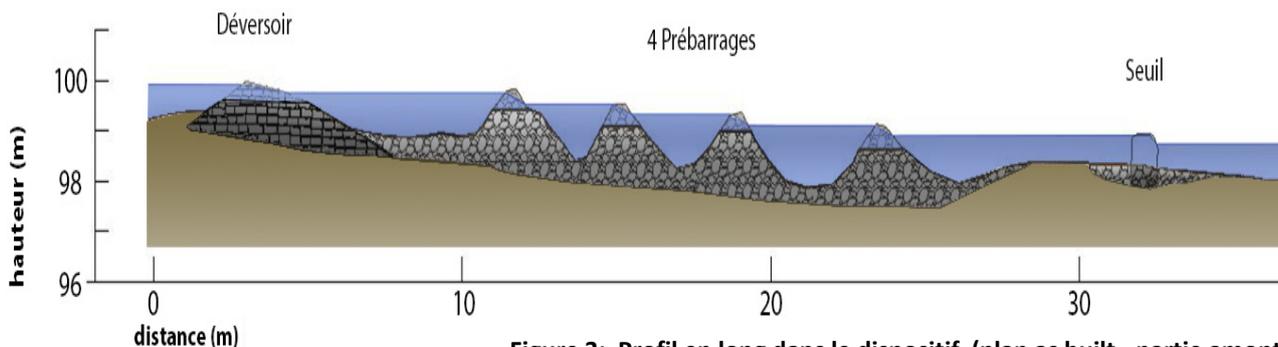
Profil en long dans le dispositif (plan as built - partie amont)
